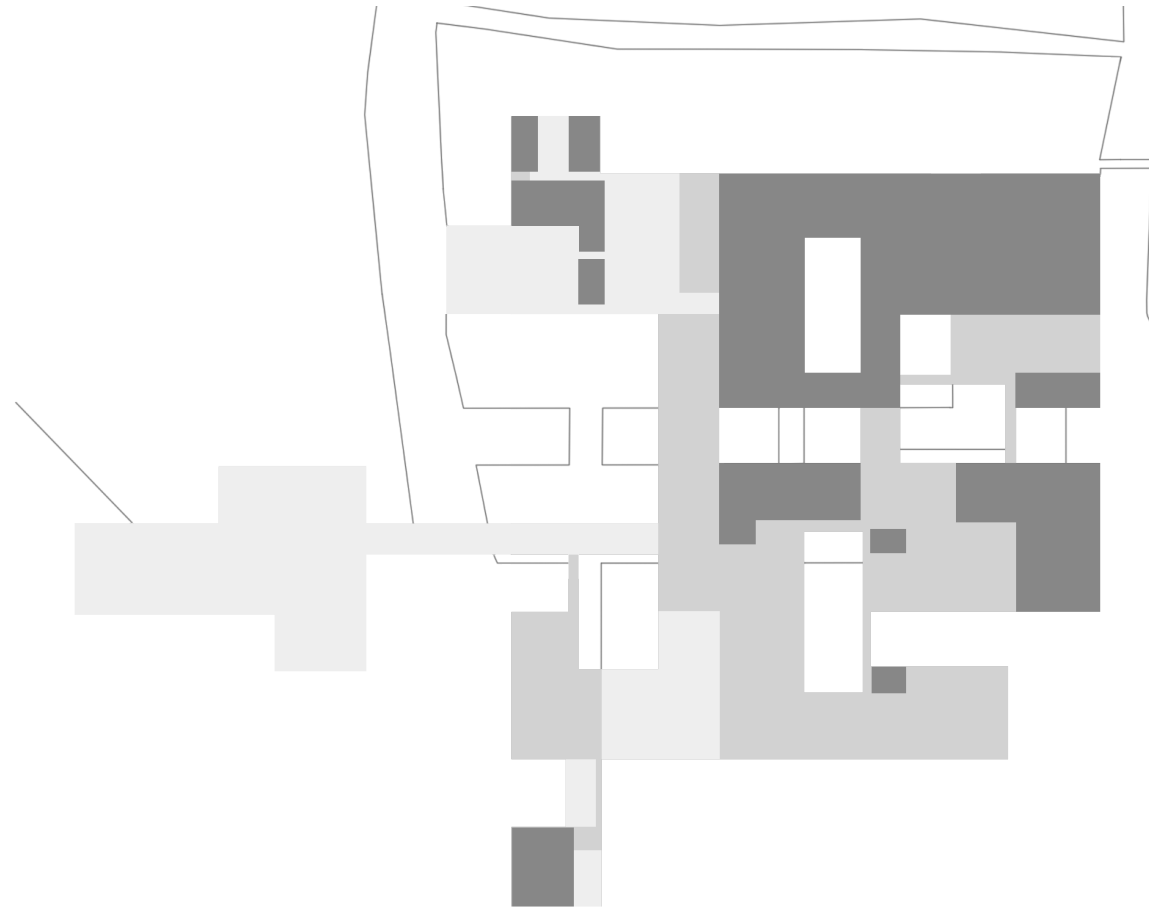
Plano lleno vacío del Hospital de Venecia. Gradación de planta baja a planta cubierta. Lo más oscuro equivale al lleno en planta baja. De oscuro a claro, los espacios cubiertos. Elaboración propia
